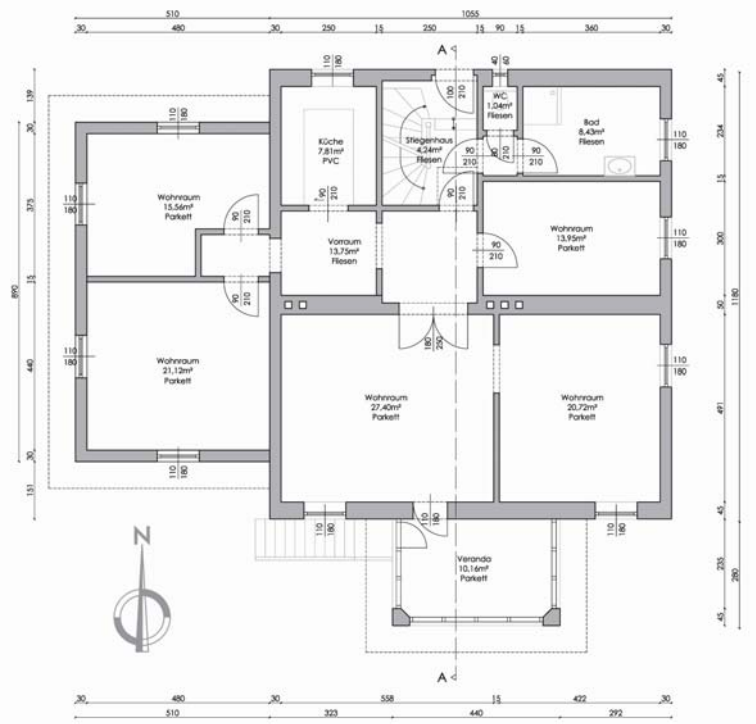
Modell EFH – Grundriss Erdgeschoß 1:200
